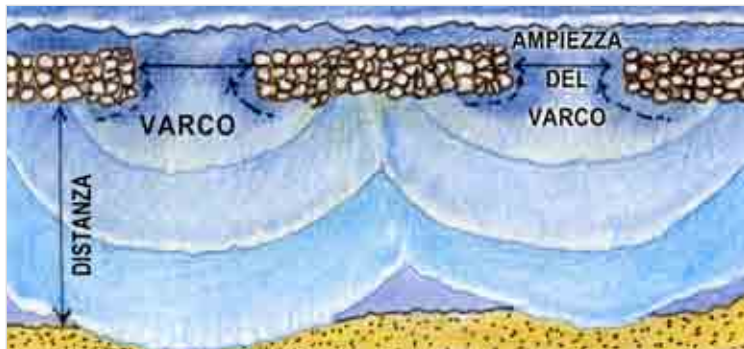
elementi strutturali delle barriere parallele alla spiaggia.
